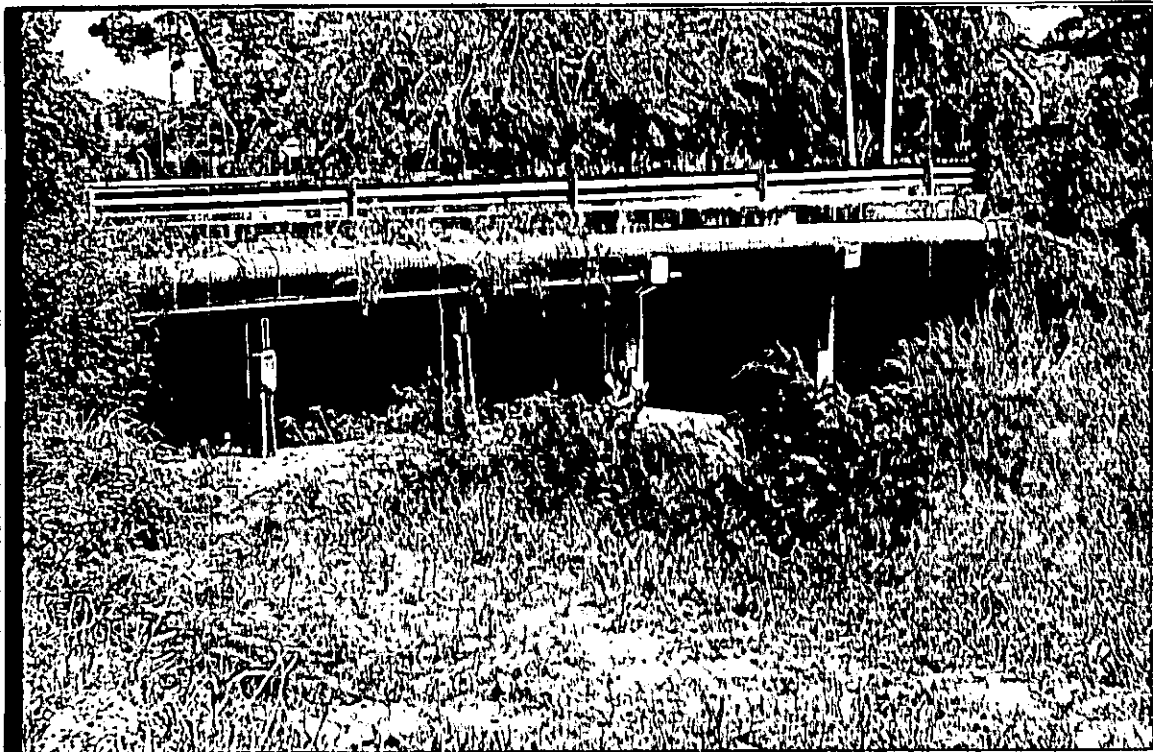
Arroyo Grande .Salida del culvert sobre la Via Mamonal.
